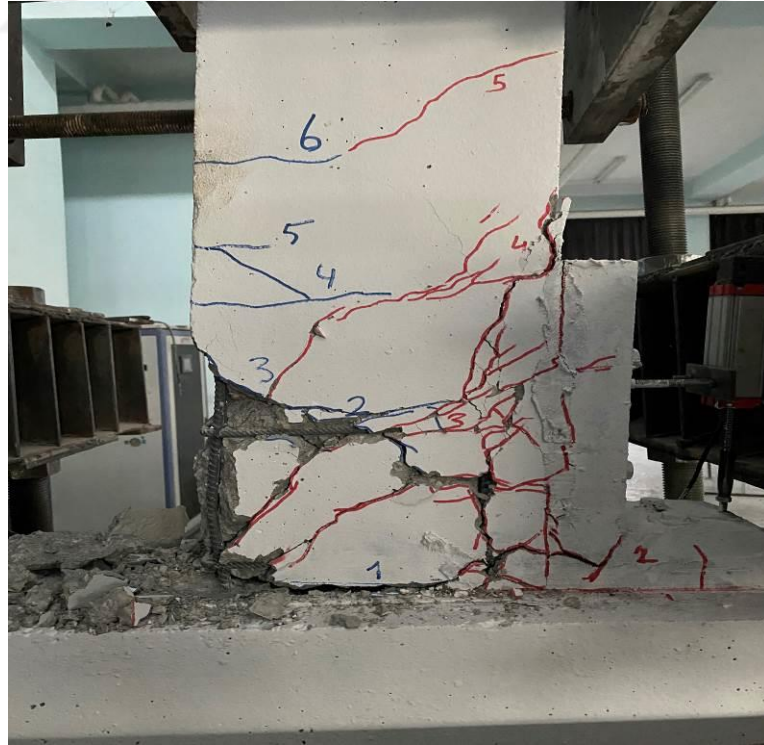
RB-LDB1-SE deney elemanında kullanılan panelde oluşan ayrılma
